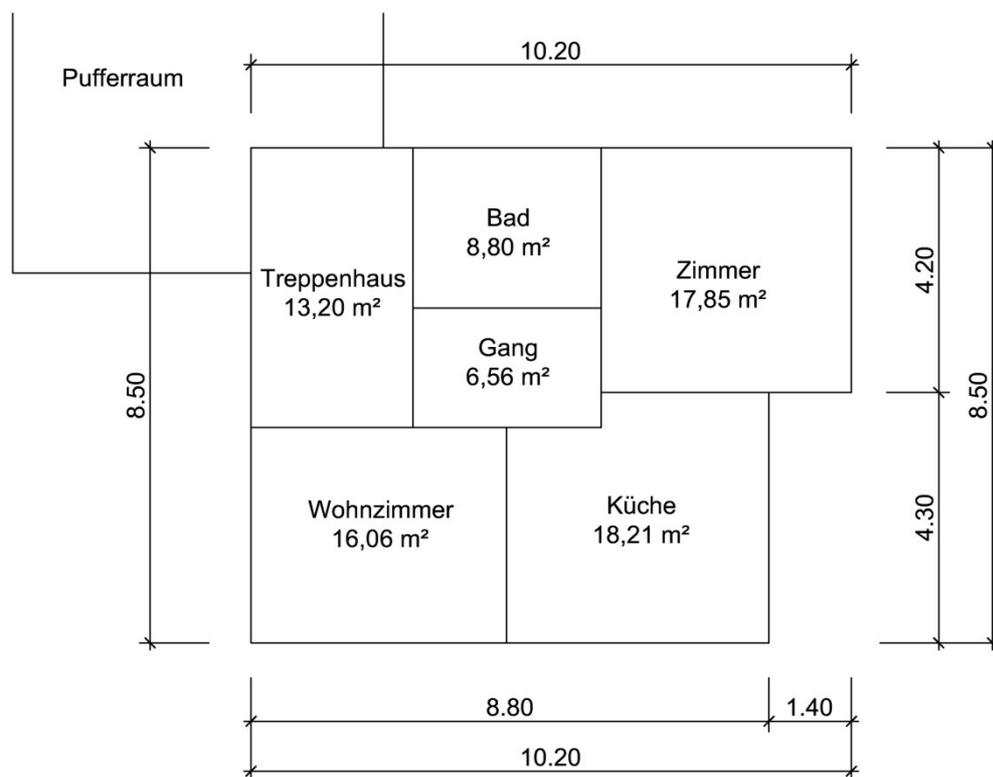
Grundriss: unkonditioniertes Obergeschoss
